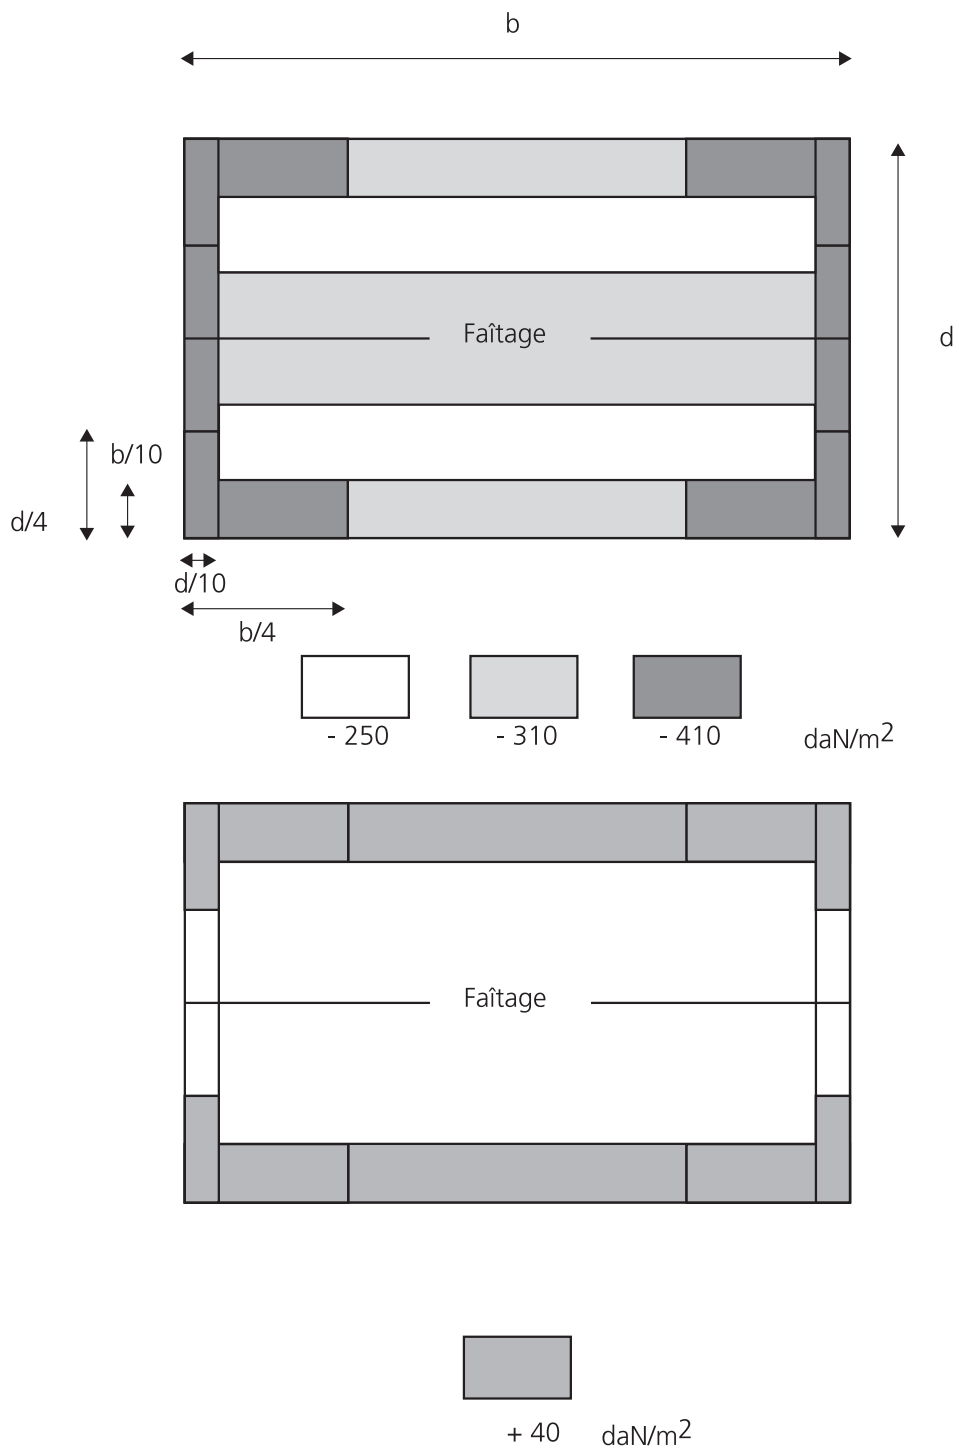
Charges forfaitaires d'arrachement et d'écrasement sur une toiture à deux versants de pente = 15° - h ≤ 10 m
